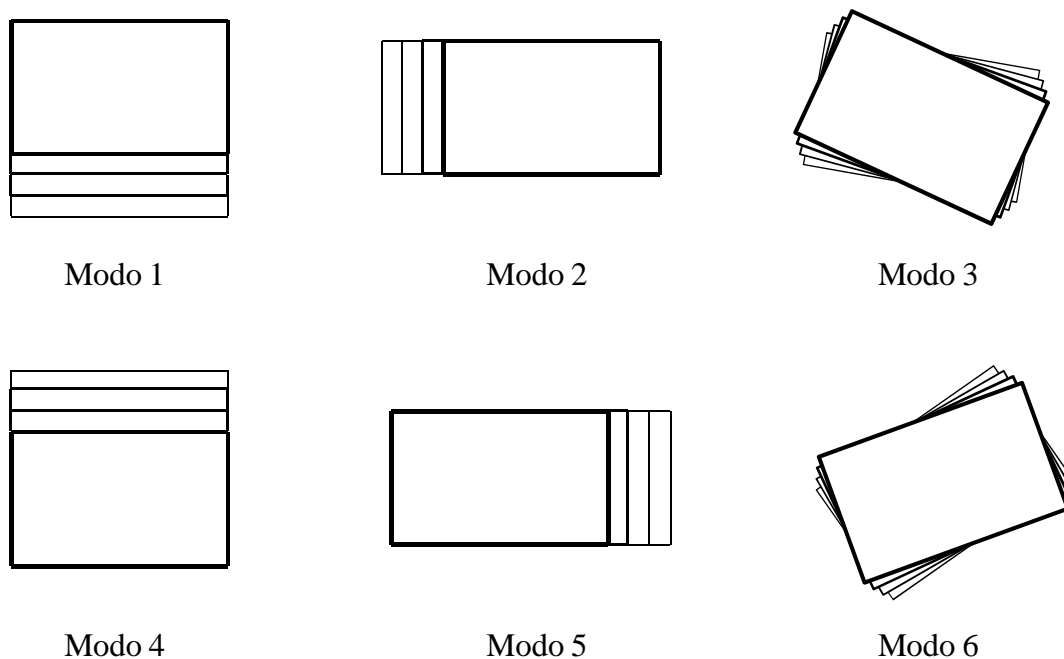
Modos de vibração do primeiro pavimento do modelo. (Carneiro, 2009).
